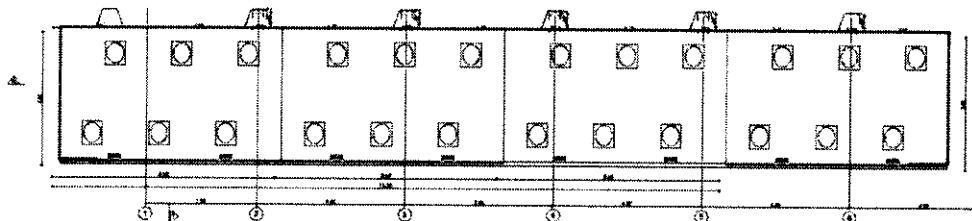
Planta de estructura tipo muelle flotante para el muelle proyectado.
